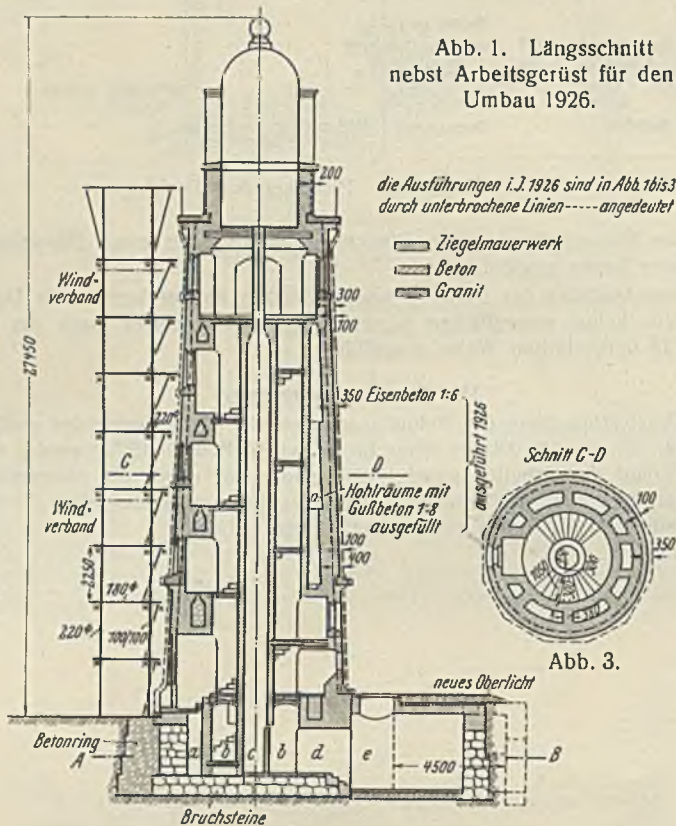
Längsschnitt nebst Arbeitsgerüst für den Umbau 1926.
